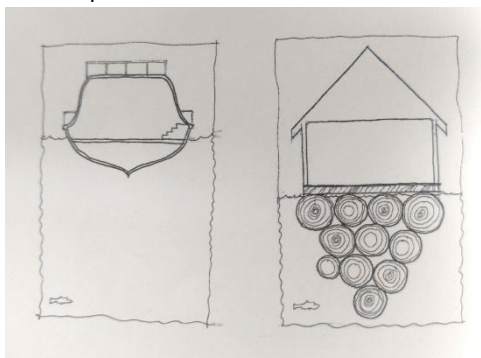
Plataforma de concreto recheada com isopor ou casco de concreto reforçado.
